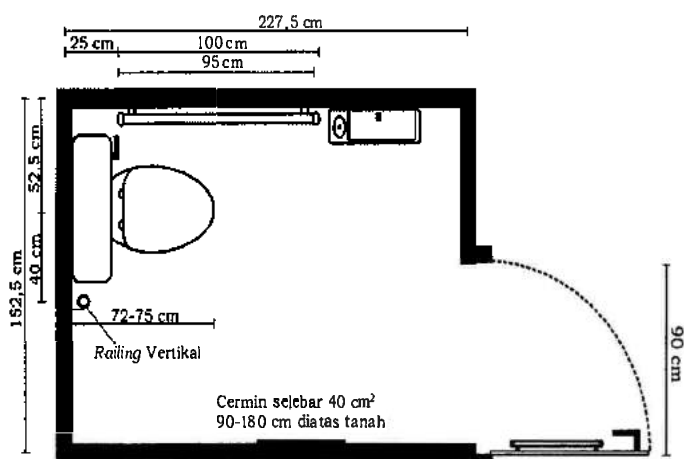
Ruang dalam toilet dengan bukaan ke dalam, tempat sampah, dan tempat barang bawaan
